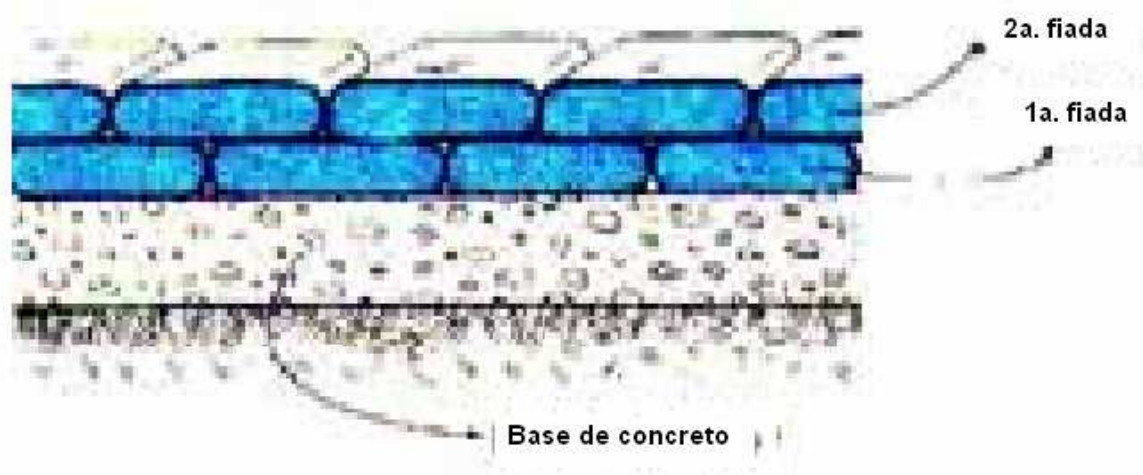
Posição das fiadas em uma construção com solo-cimento ensacado
